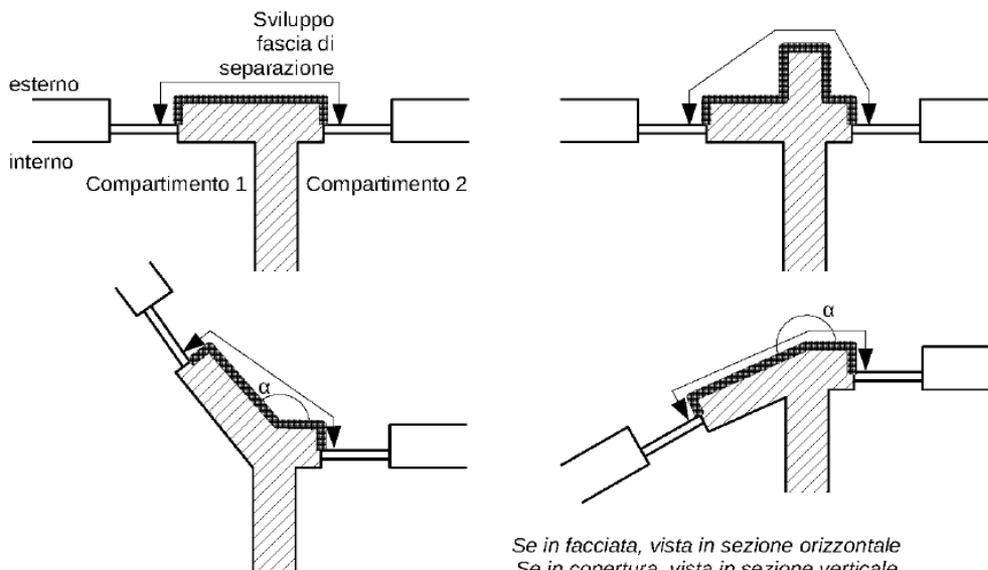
Esempi di fascia di separazione verticale in facciata o in copertura
